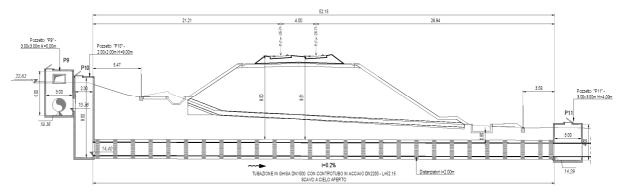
Attraversamento alla pk 30+110,00 - Sezione Longitudinale
